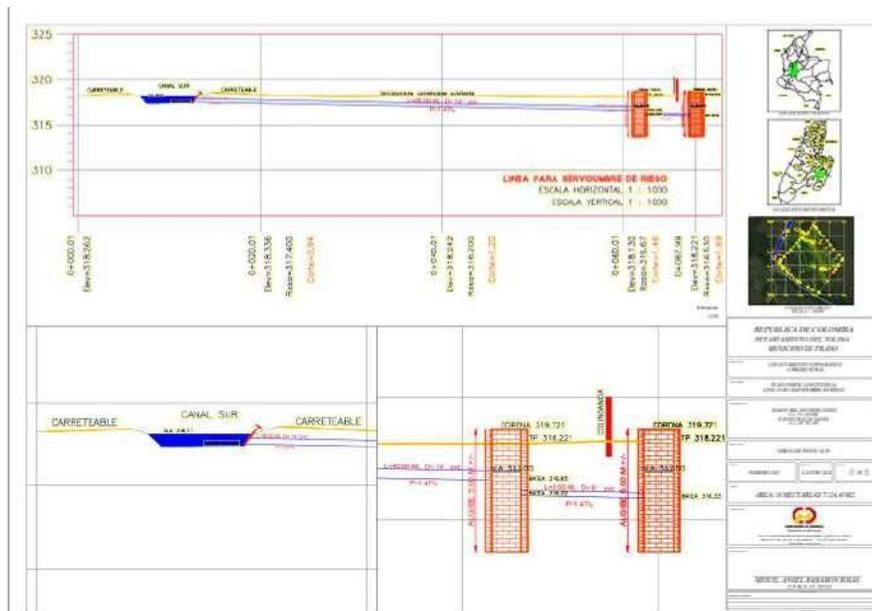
Plano del predio Lote con la ubicación de la servidumbre
